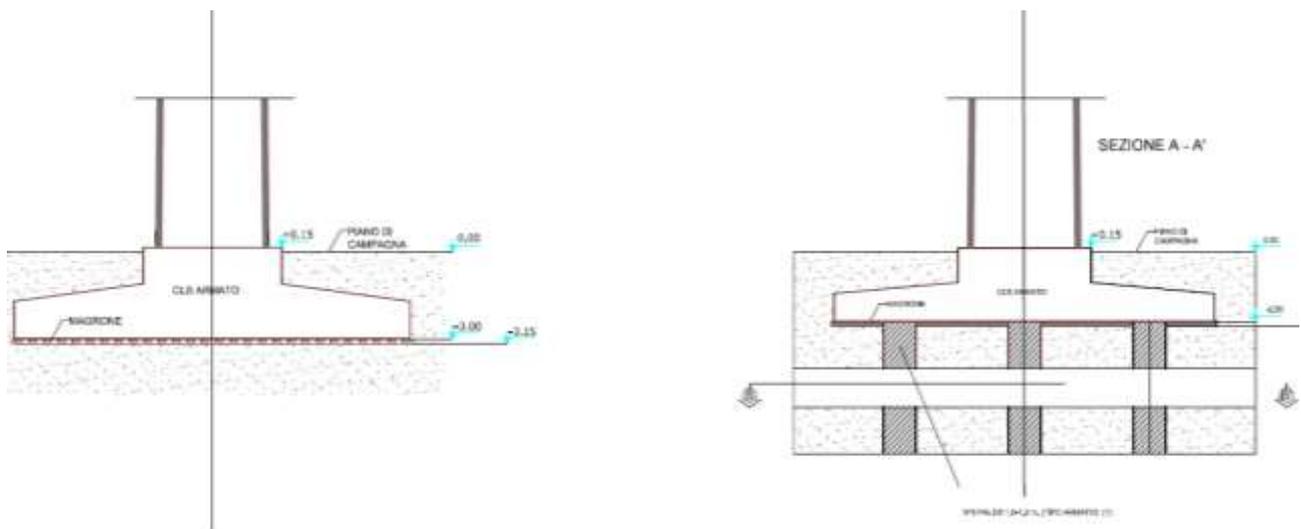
Tipico sezione fondazione (diretta e a pali)
